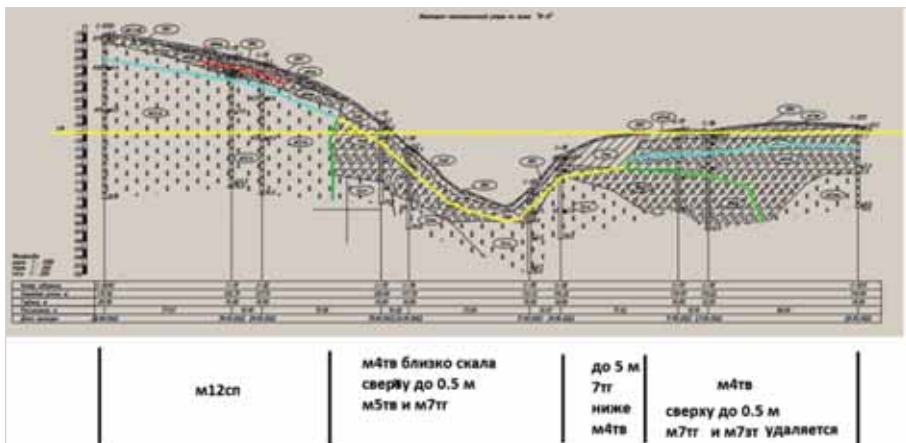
Наиболее неблагоприятный инженерно-геологический разрез с учетом наличия дисперсных грунтов, подлежащих удалению. Желтая линия, по которой осуществляется посадка типового поперечного разреза ЖГФ
